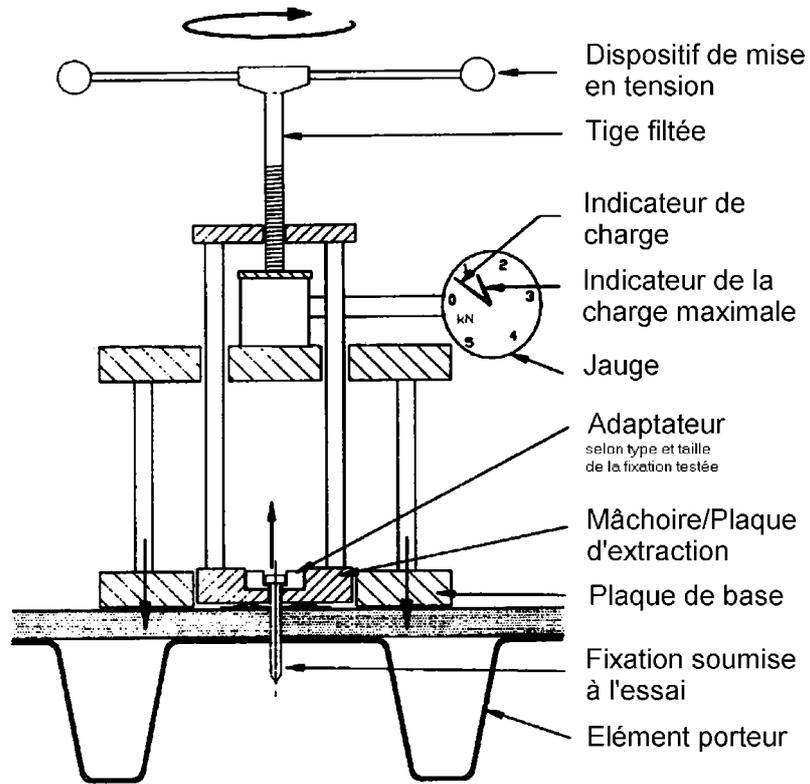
Principes d'un essai d'arrachement sur chantier
